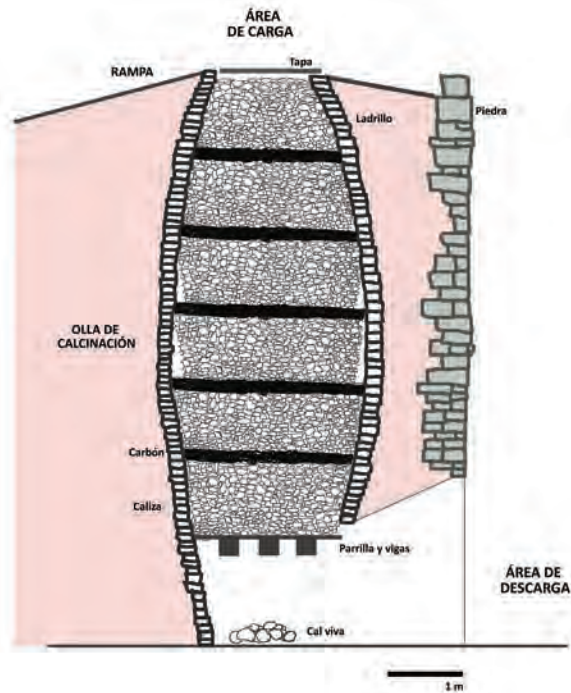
Croquis de corte longitudinal del horno de quema continua Ho1 y detalle de su funcionamiento.
